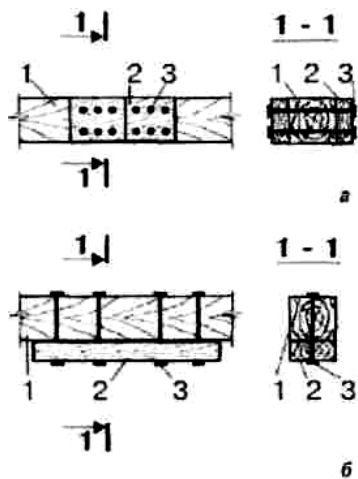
Схеми підсилення дерев'яних балок різними накладками:
